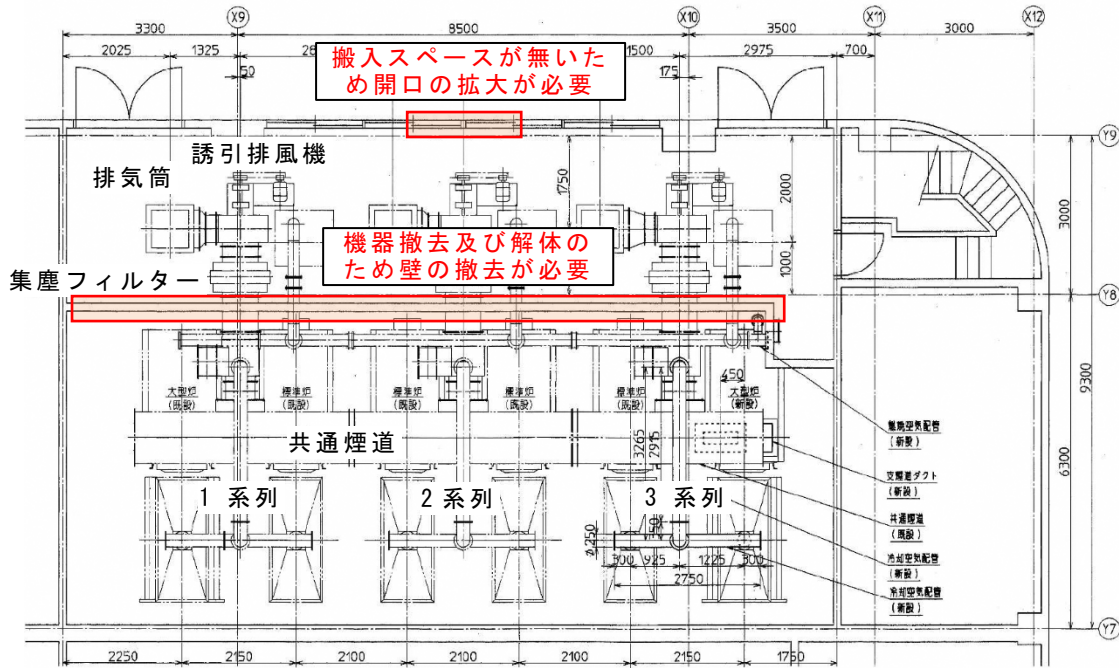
火葬炉 6 基の入替えの場合の想定される建物改修（平面図）
